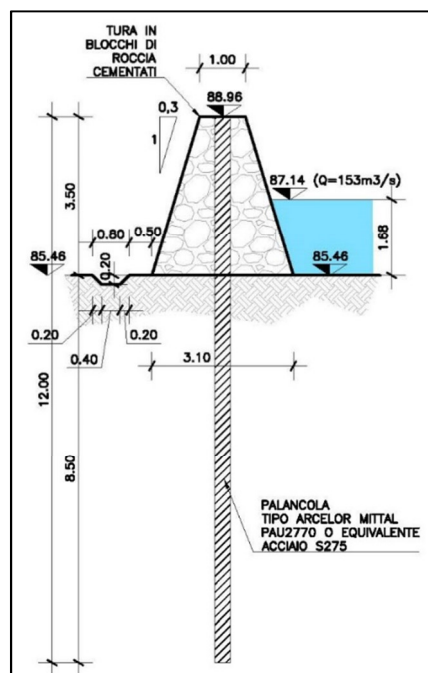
Opere di chiusura in massi cementati - Stagione 2 - Sezione tipo a monte del Manufatto
